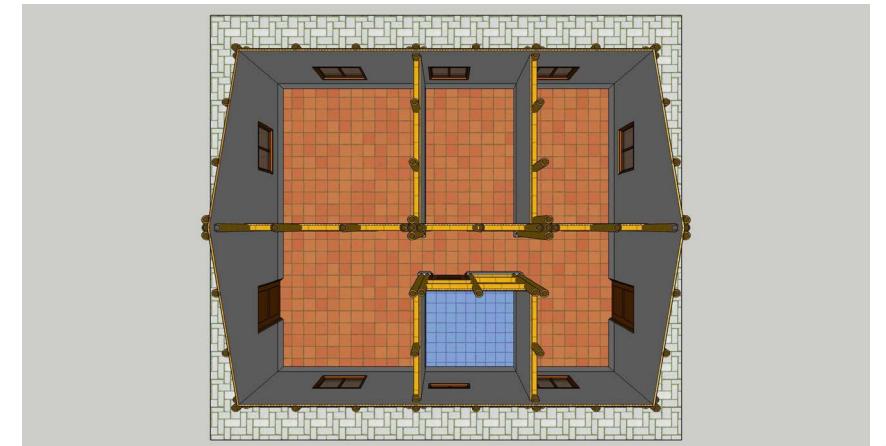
[Figura] Planta única Libertador Bolívar. Fuente: Bambu Arquitectura
